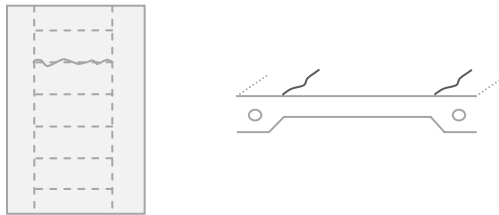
Esquema de fissura: assentament plàstic.
